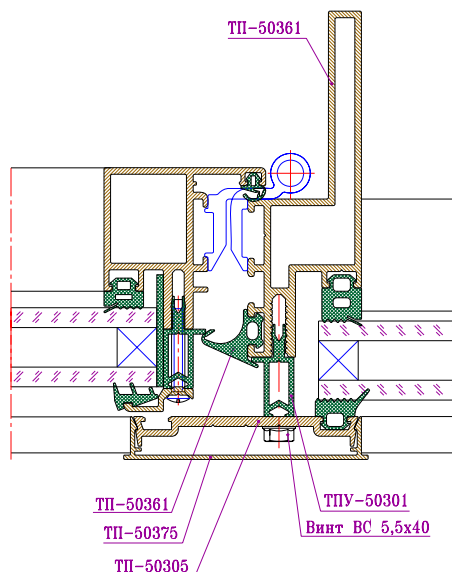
Установка уплотнителя ТПУ-005ММ, термовставки ТП-50301 на участках со скрытой створкой
